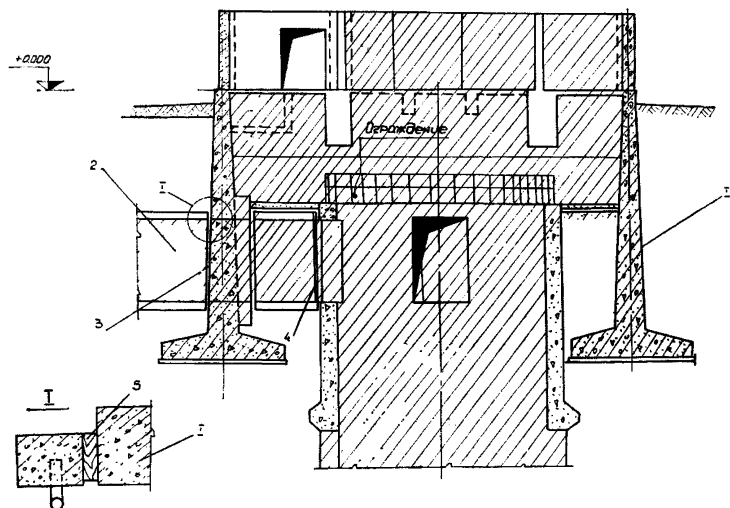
Примыкание монолитного железобетонного фундамента к вентиляционному каналу:
